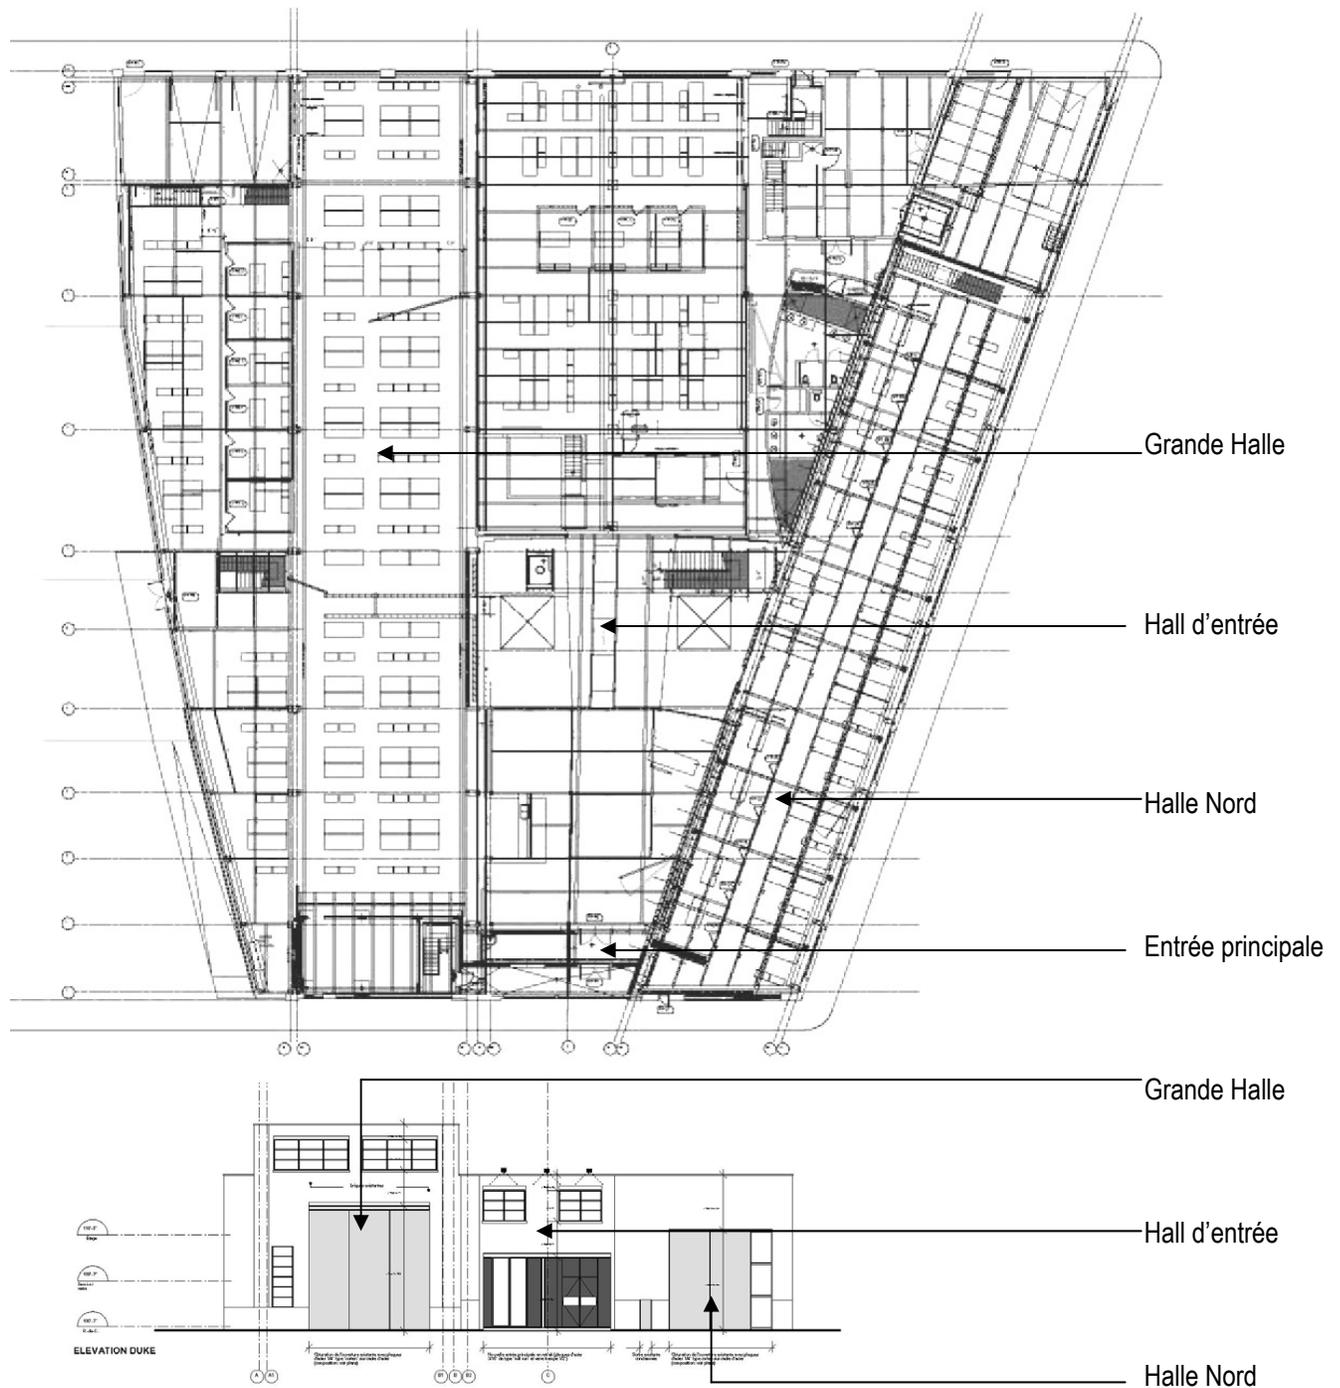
(A) Plan du rez-de-chaussée et (B) élévation rue Nazareth (Source : Atelier in situ)
